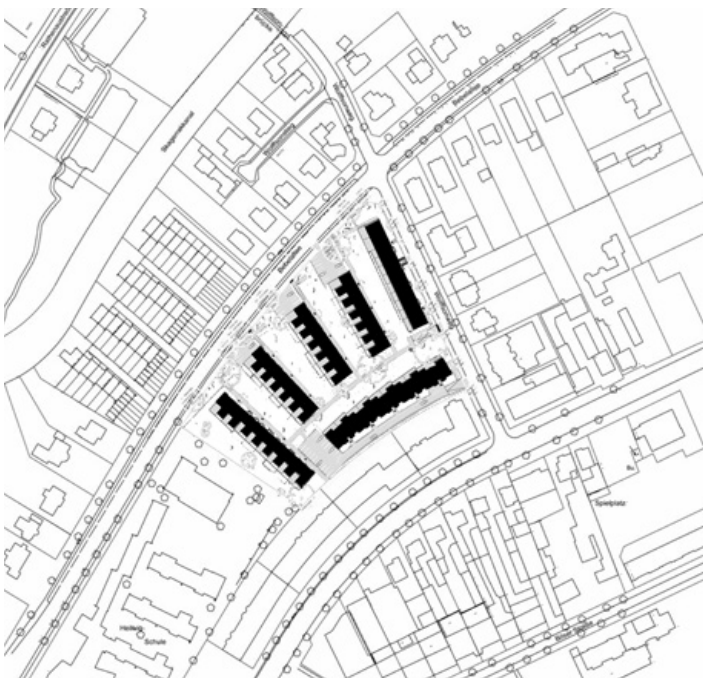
Lageplan, Quelle: Blauraum Architekten
